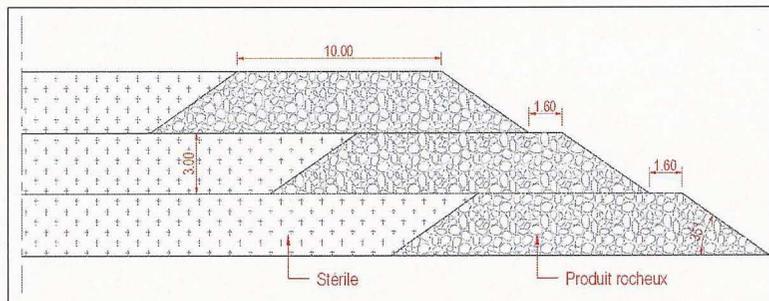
Schéma conceptuel pour la construction d'un niveau de 9 m
